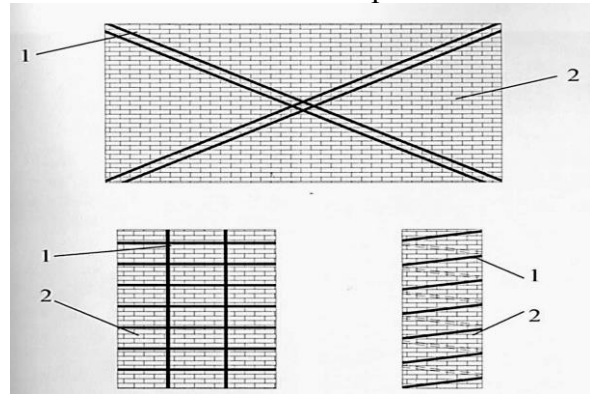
Варианты нанесения усиливающих лент на стены: 1 – лента усиления; 2 – кирпичная стена
